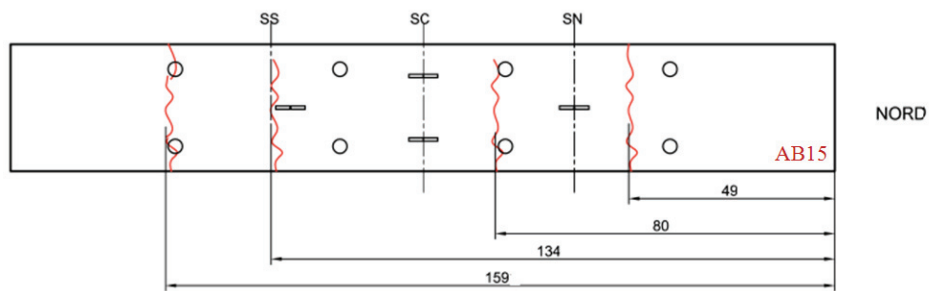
Relevé des fissures pour la poutre AB15
